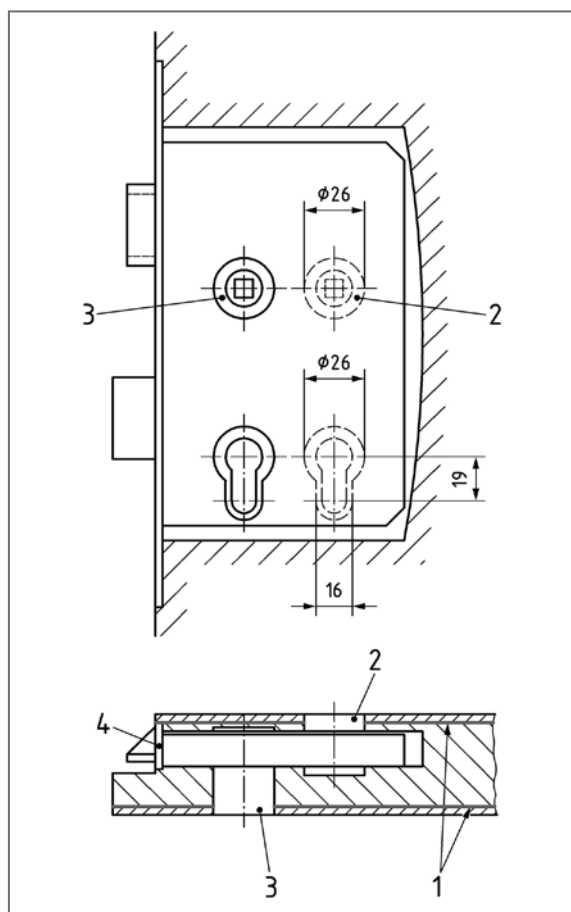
Detailschnitte Schlosseinbau [Quelle: Bild A.6, DIN 6834-1:2012-06, durch Verfasser leicht verändert]
